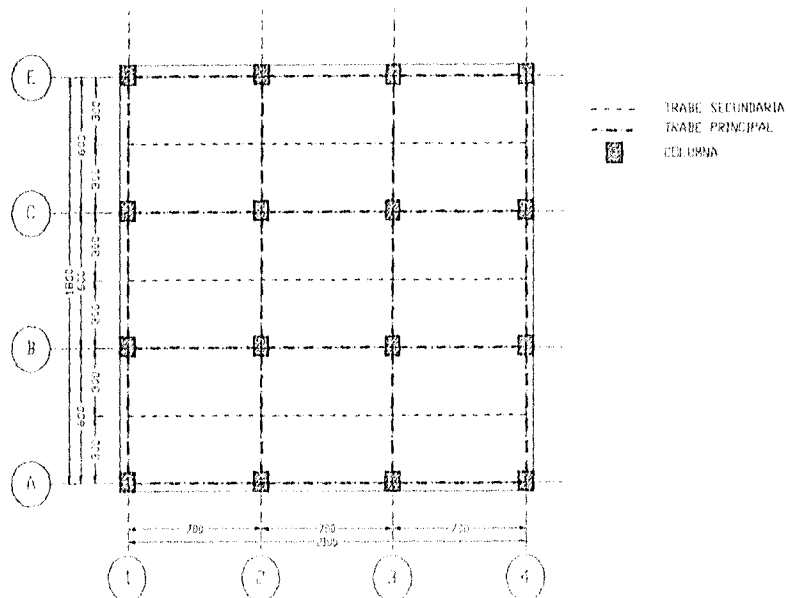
Planta tipo de los 3 edificios de concreto reforzado analizados.
